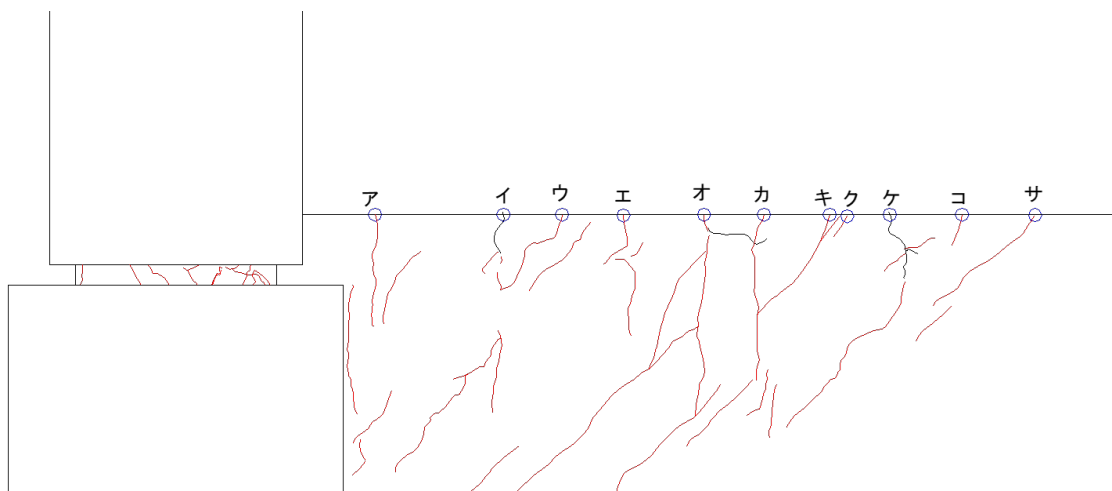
基礎梁ひび割れ幅測定位置 (試験体 A-1 負載荷)
